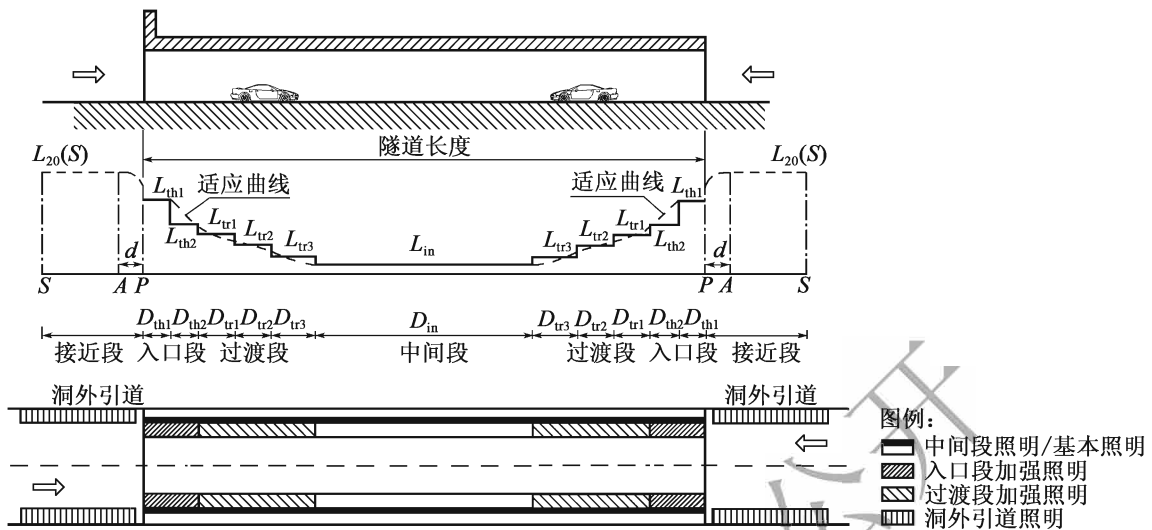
Schéma des sections du système d'éclairage des tunnels routiers à deux sens
